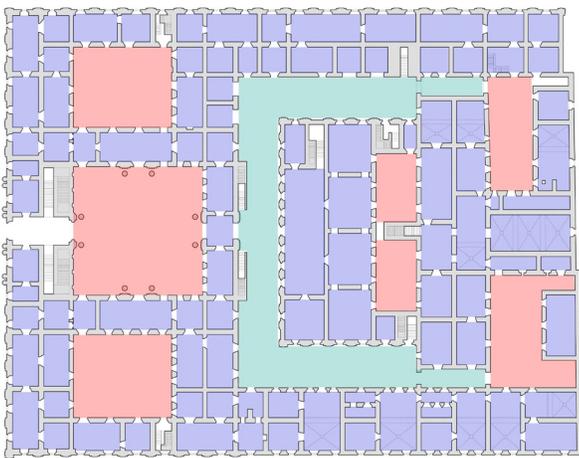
Elementos Palacio de La Moneda en planta primer nivel. Elaboración propia.
